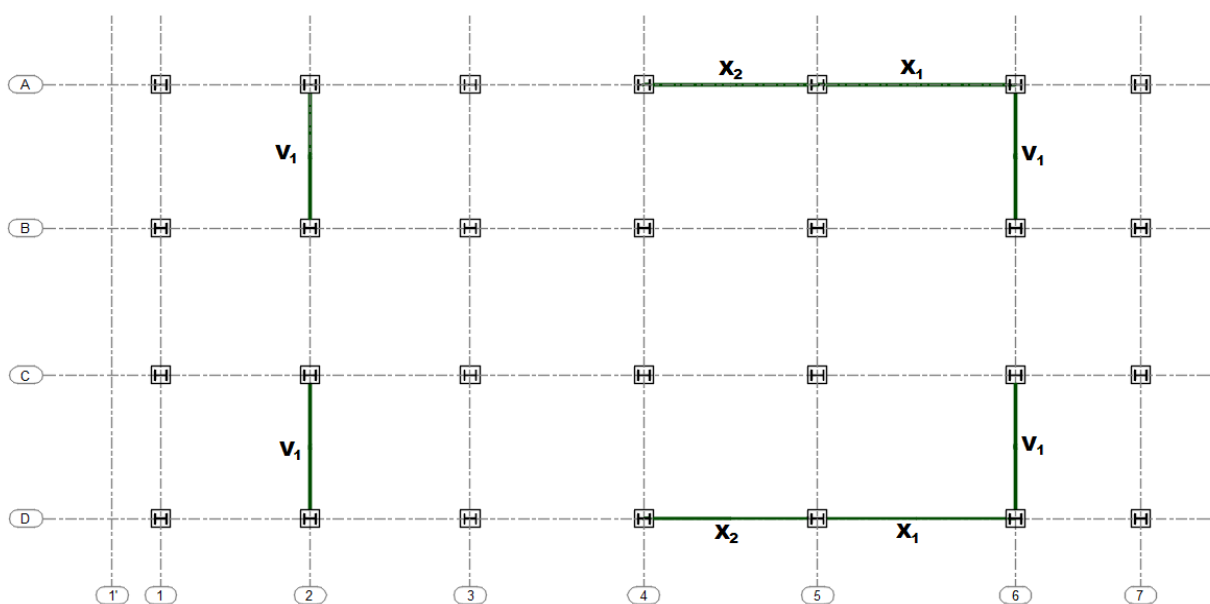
Disposition des contreventements pour l'ossature mixte (acier, béton)
